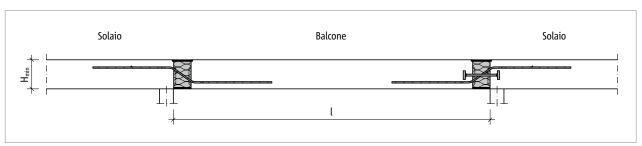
Schöck Isokorb® XT tipo QP-Z, QP: schema statico
